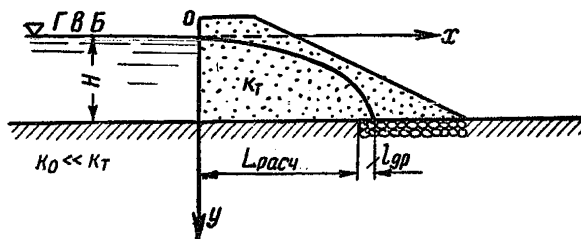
Расчетная схема для плотин с горизонтальным дренажом
